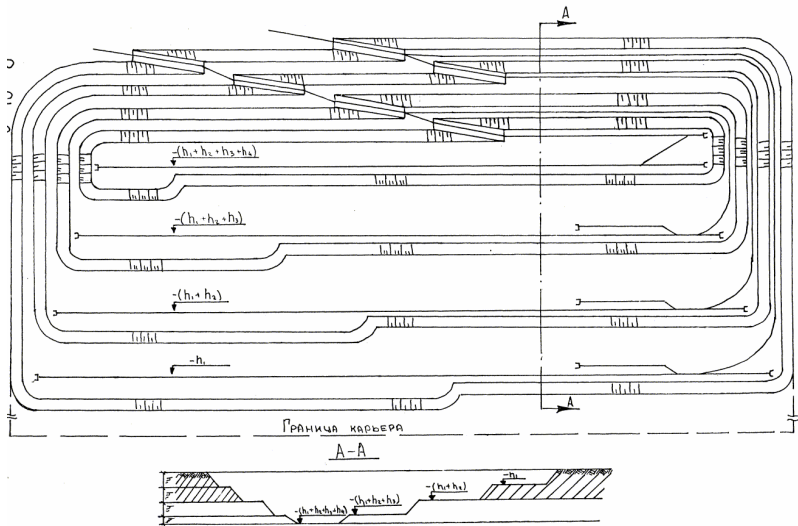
Схема вскрытия внутренними групповыми траншеями
